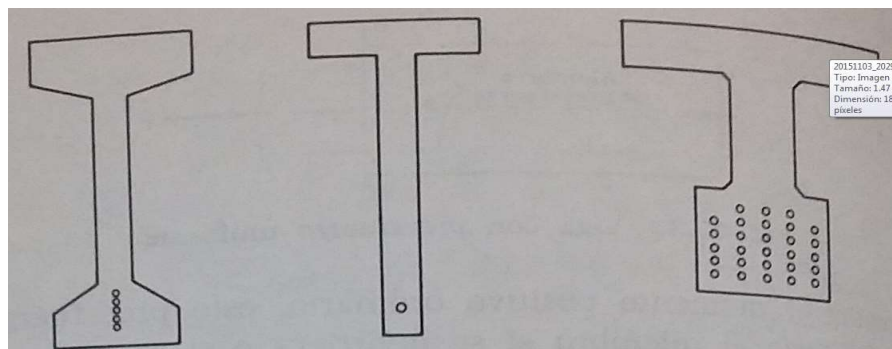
secciones transversales de vigas presforzadas (Fuente: FERGUSON, 2005, págs. 551-558)
